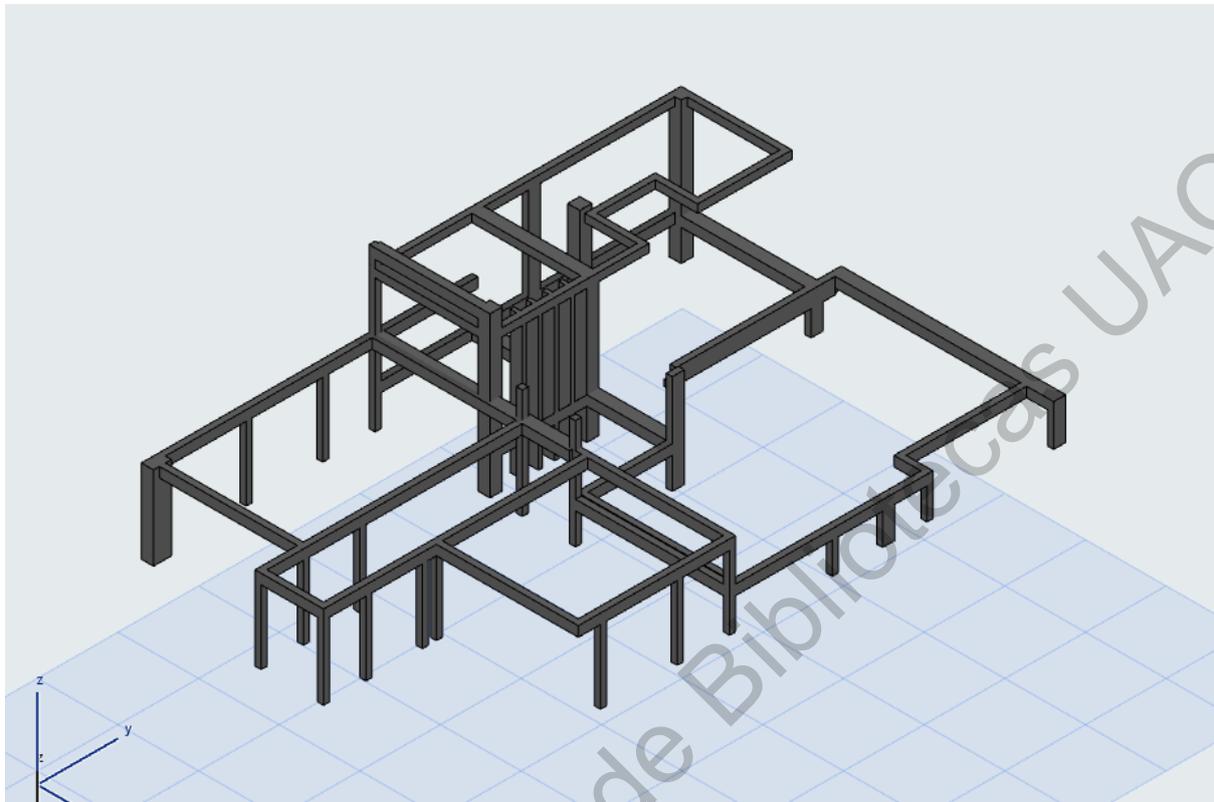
Columnas de concreto, Vigas de concreto y Viga de acero de Segundo Nivel y Planta de Azoteas de Proyecto 003.
